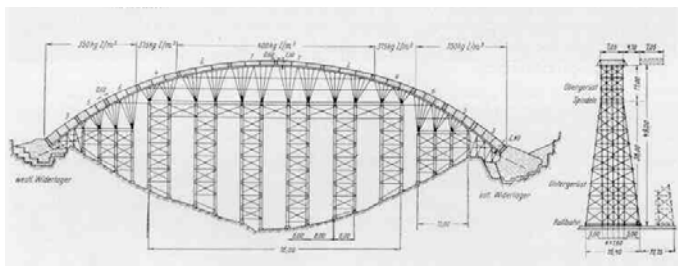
Стоманобетонен дъгов мост във Велико Търново (Concrete arch road bridge....).
